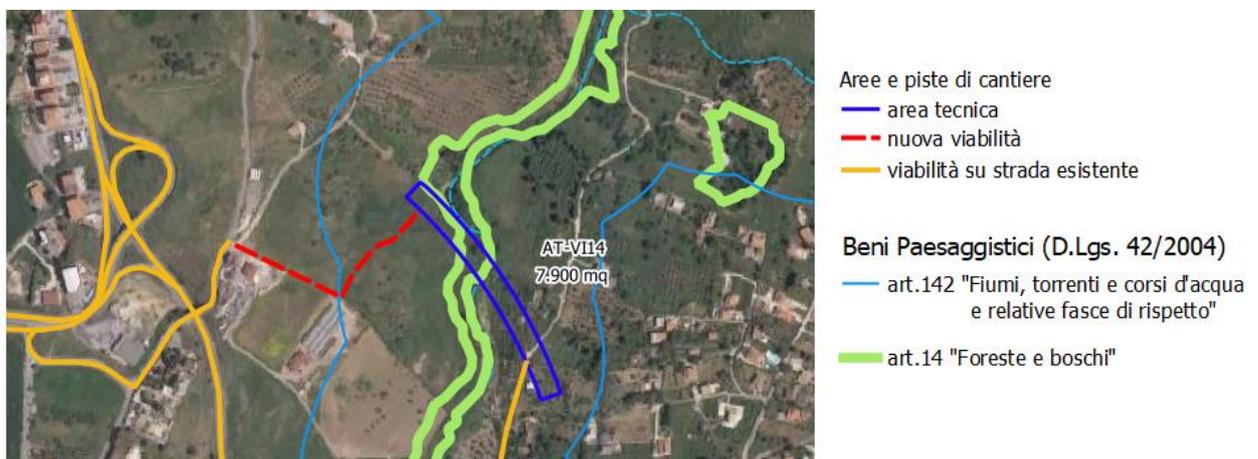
localizzazione della pista di cantiere rispetto l'area vincolata
